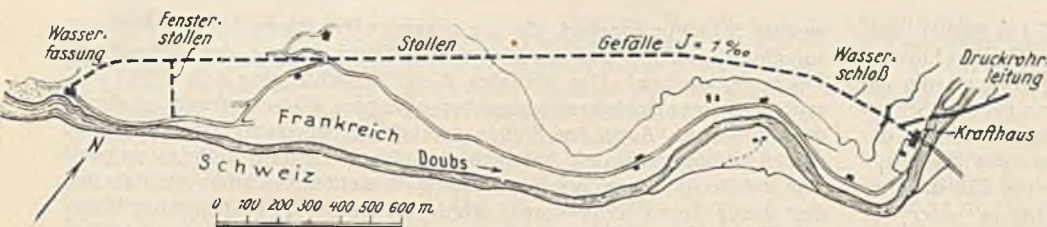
Lageplan der Wasserkraftanlage Refrain im Doubs.
